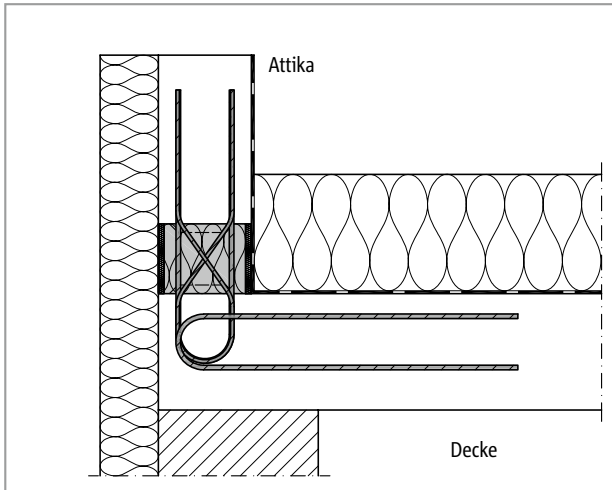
Schöck Isokorb® XT Typ A mit Brandschutz
